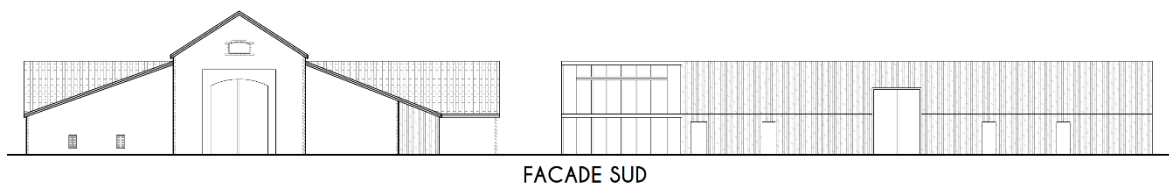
Façade principale « Sud » : Grange, Serre et Halle de création
